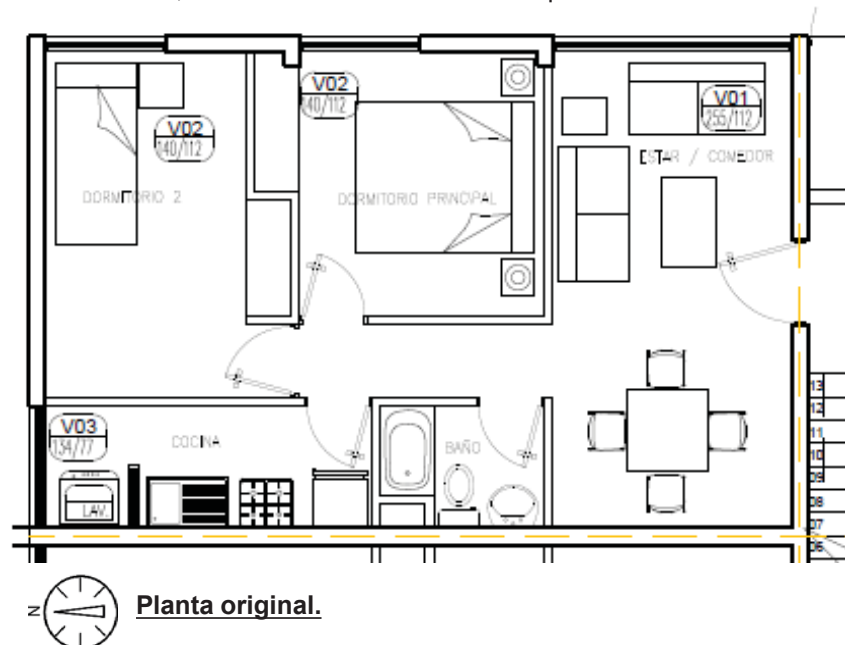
Planta original de una vivienda. Fuente: Elaboración propia.
